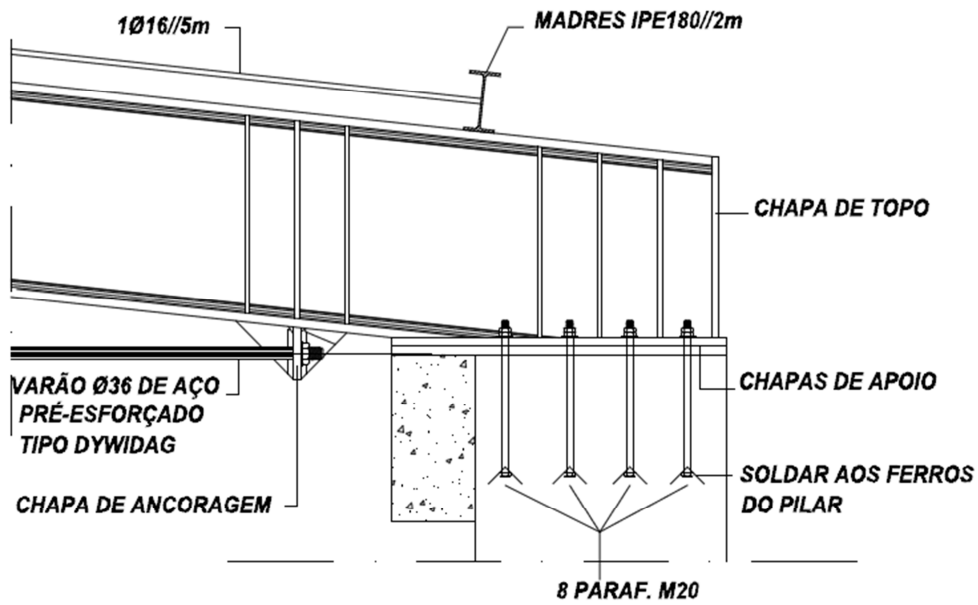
Pormenor da Ligação pilar - viga e ancoragem da barra.
